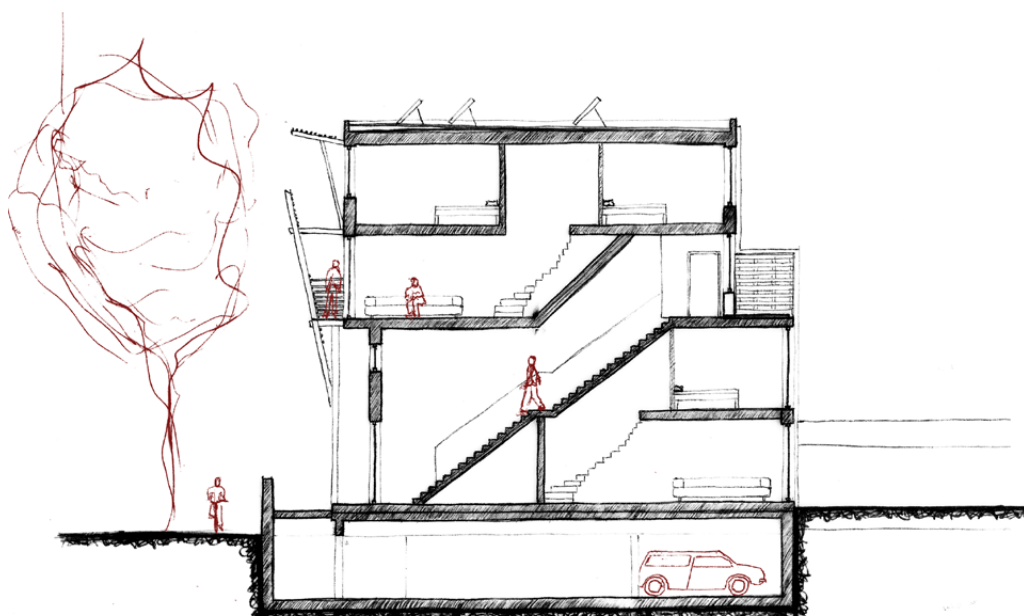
Sección transversal A-A' l'Espoir Bursseles
